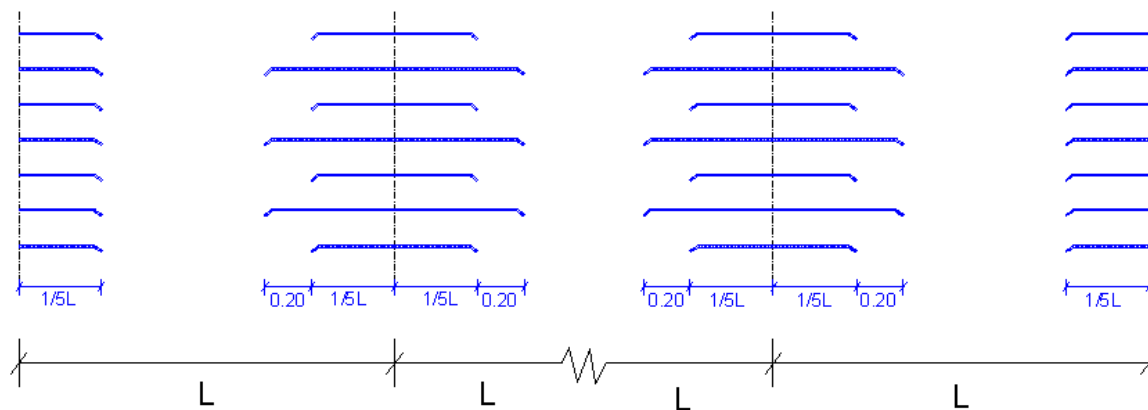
Disposição das armaduras de momentos negativos em planta.
